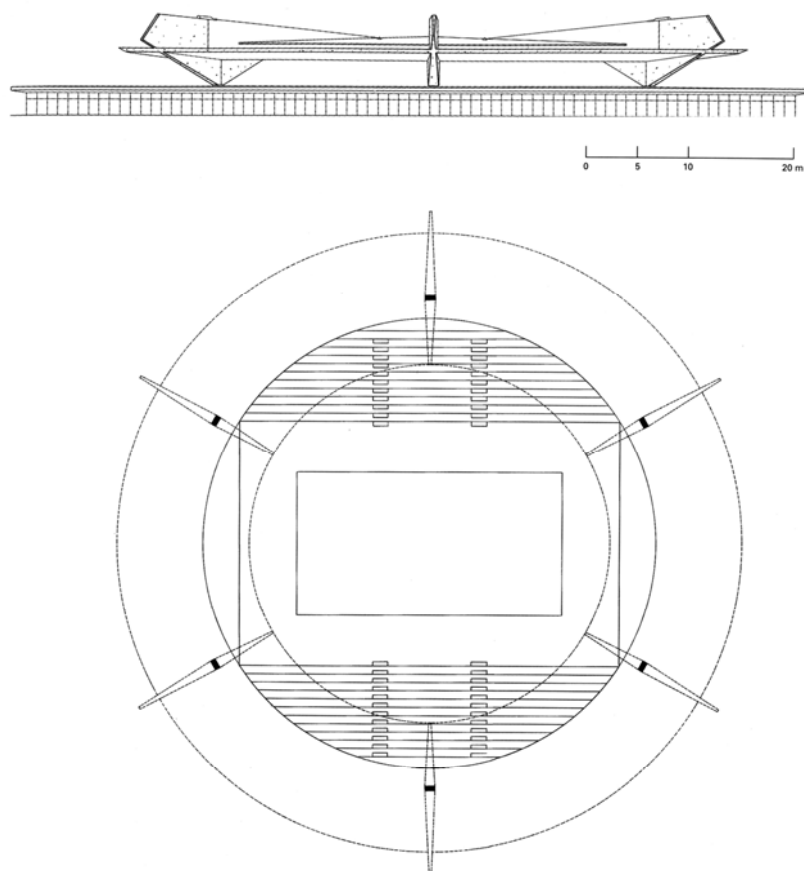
Ginásio do Paulistano. Elevação e planta do nível 5,00.
